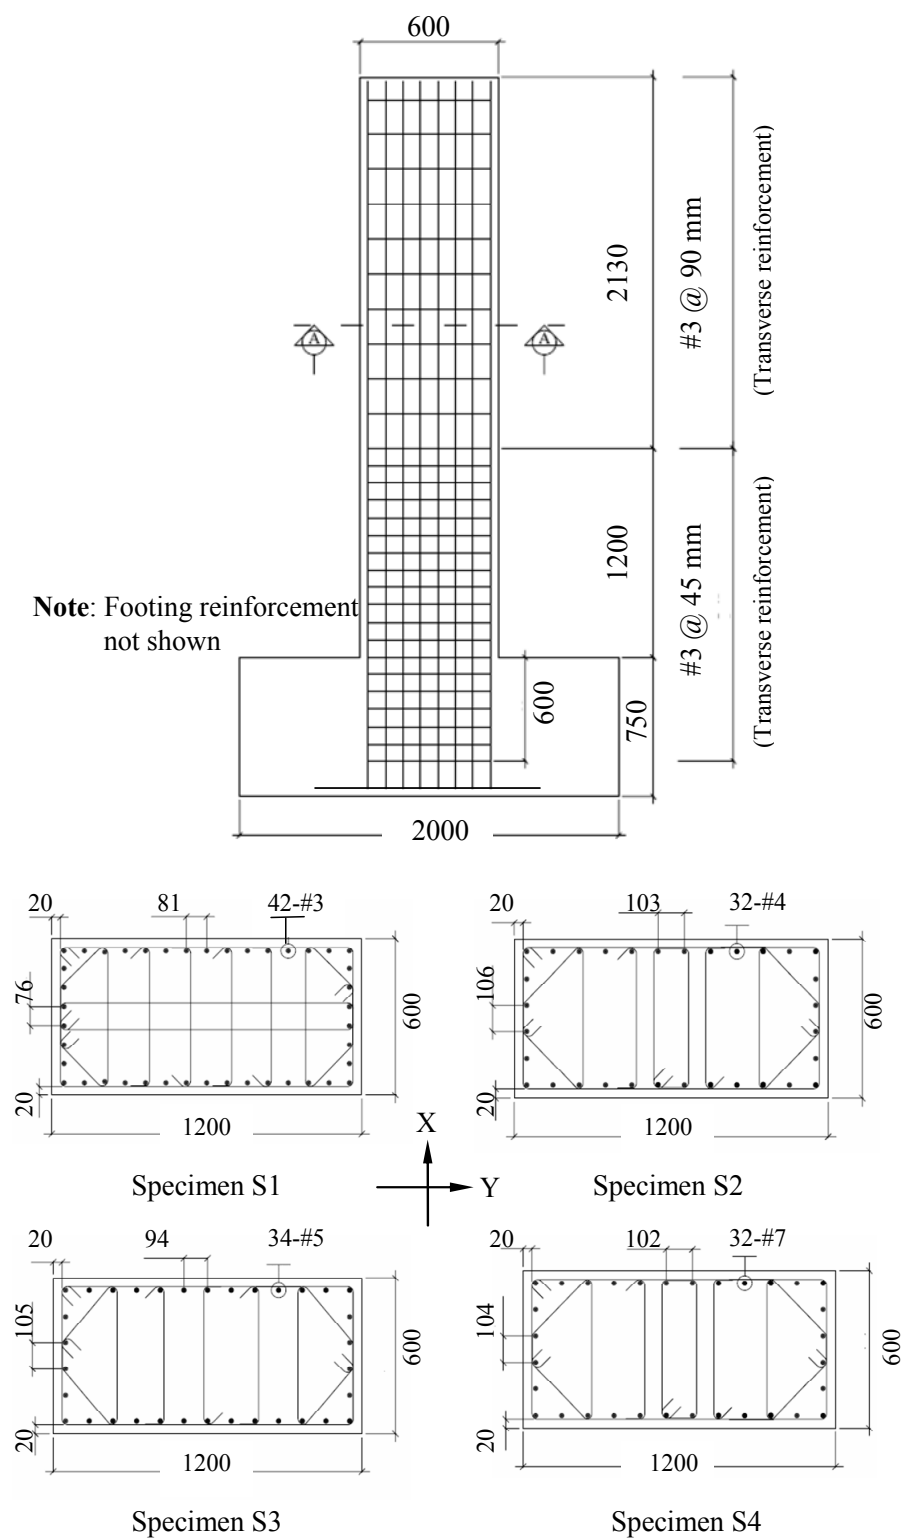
Détails de disposition de l'armature longitudinale et transversale des spécimens testés (dimensions en mm).
